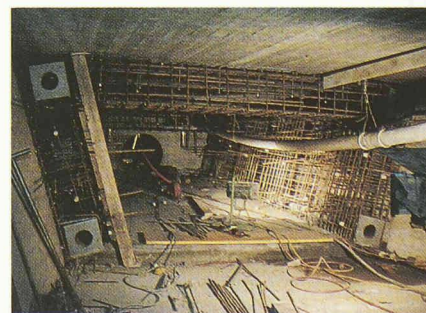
Renforcement de la superstructure: armature et précontrainte. (Photo A. von Glutz.)
